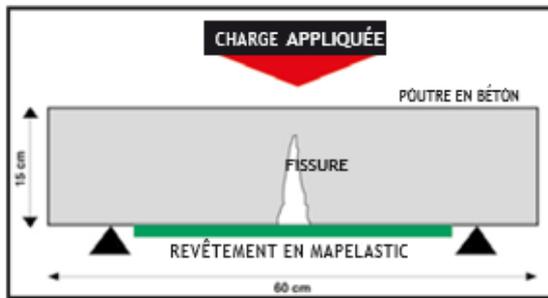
Protection d'une fissure avec Mapelastic Zero en sous-face d'une poutre en béton sollicitée en flexion
